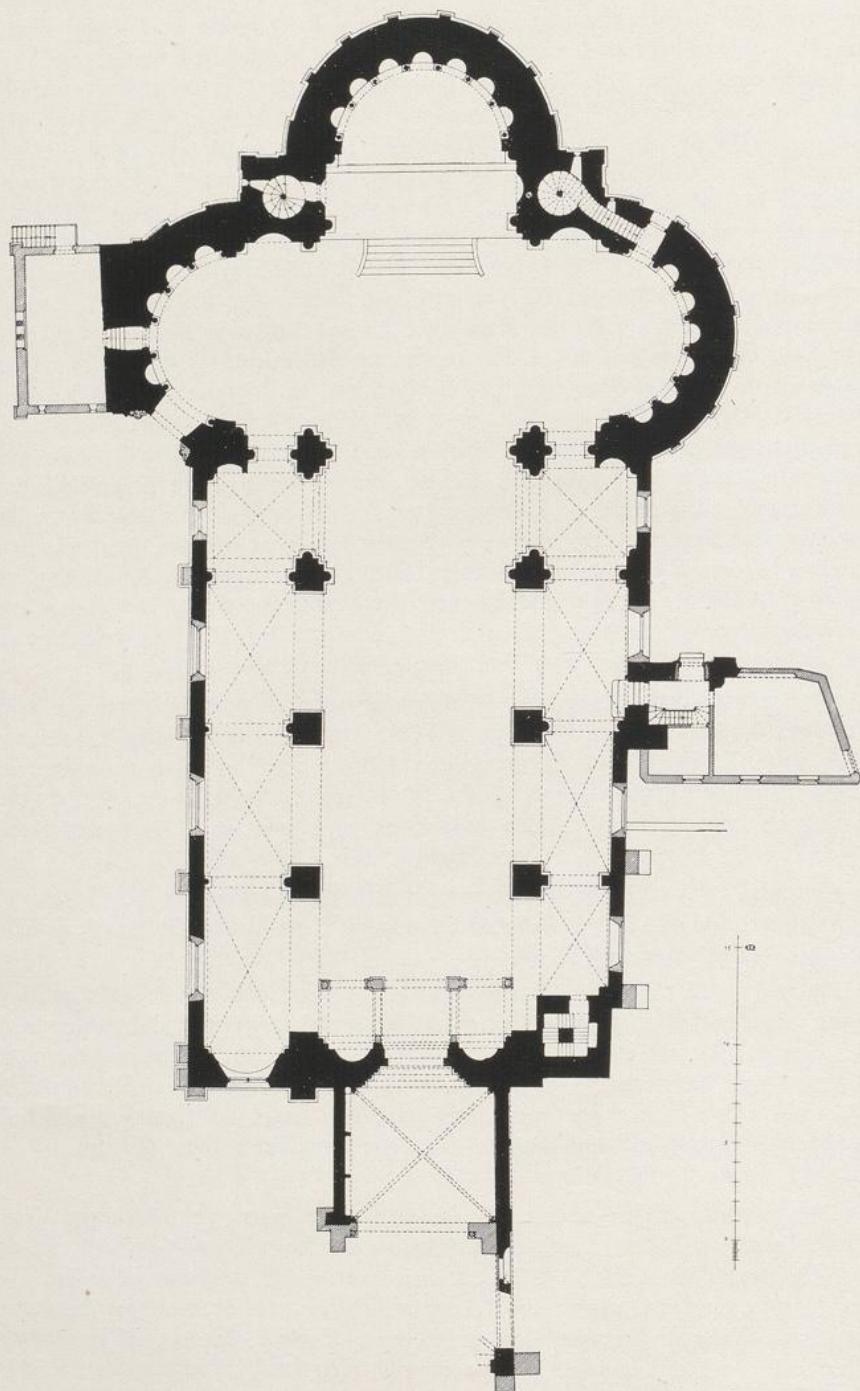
Gross St. Martin. Erdgeschossgrundriss.
